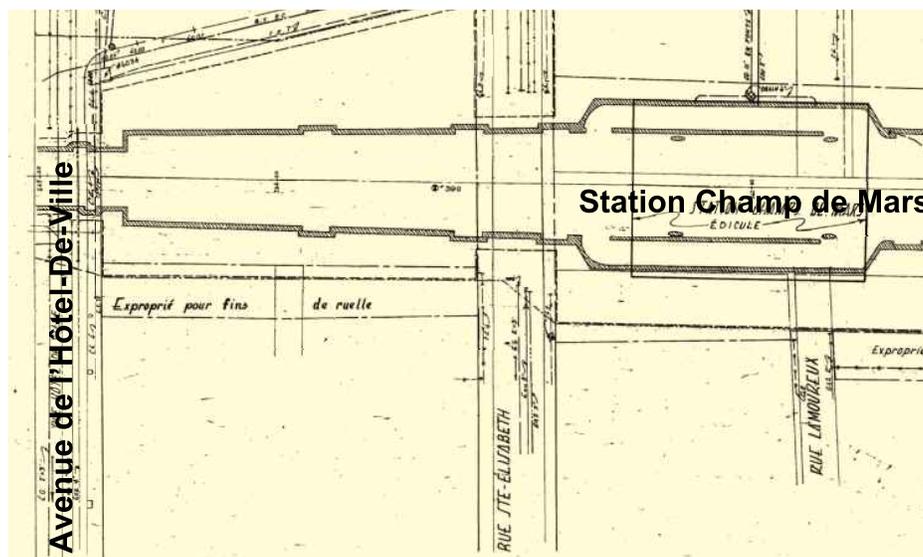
Vue en plan de la variation de section du tunnel au niveau de la station Champ-de-Mars (source : STM 1964, Plan de localisation des utilités, No. 5506)
